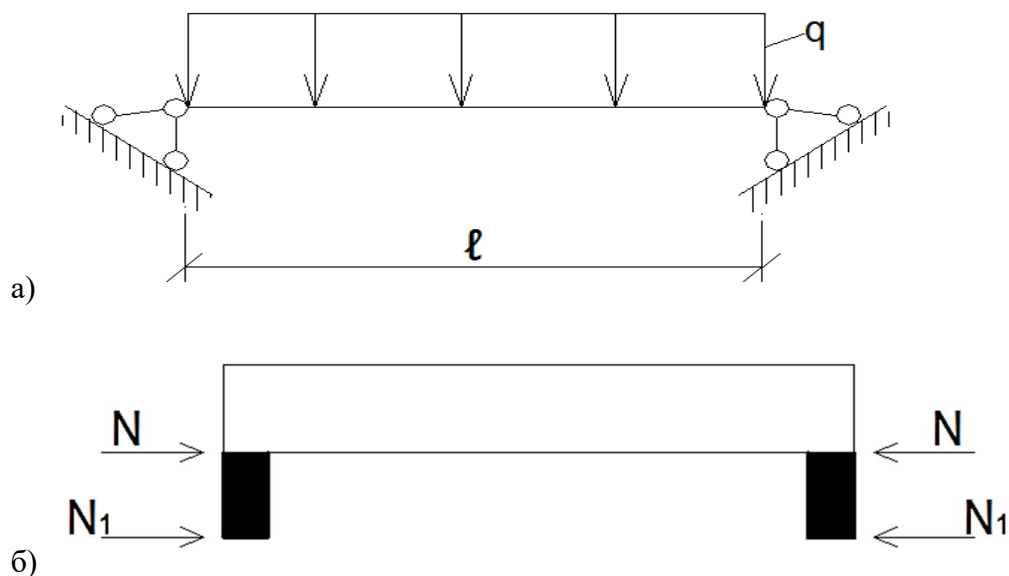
Расчетная схема плиты перекрытия в упруго-пластической стадии: а) балка на двух шарнирных неподвижных опорах; б) плита как рамная система (конструкция)
